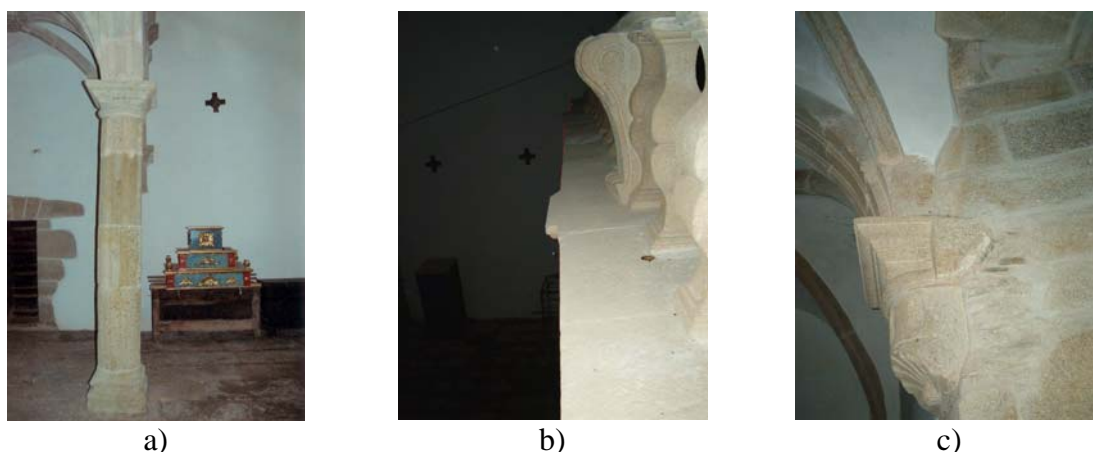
a) Desaprumo de um dos pilares de apoio do coro; b) Deslocamento do coro junto à balaustrada; c) Apoio das abóbadas do coro junto à fachada principal
